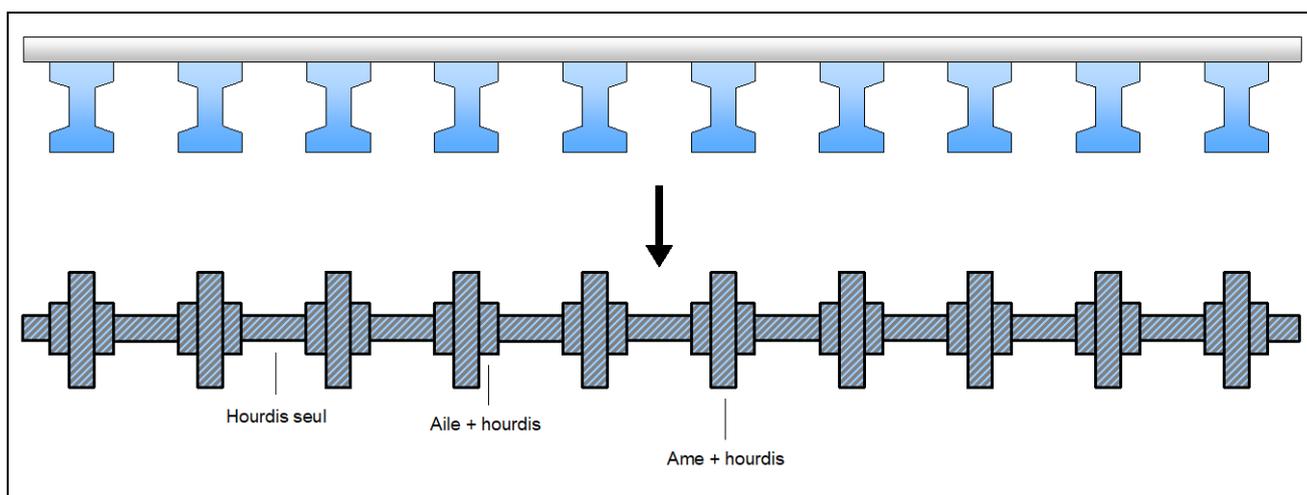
Modélisation des PRAD Classiques avec des plaques orthotropes : cas des poutres en I
